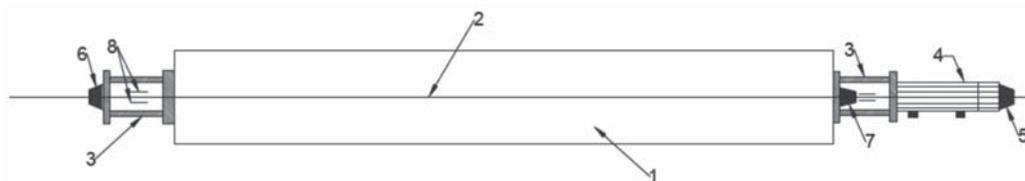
Схема натяжения арматуры на ячеистый бетон:
